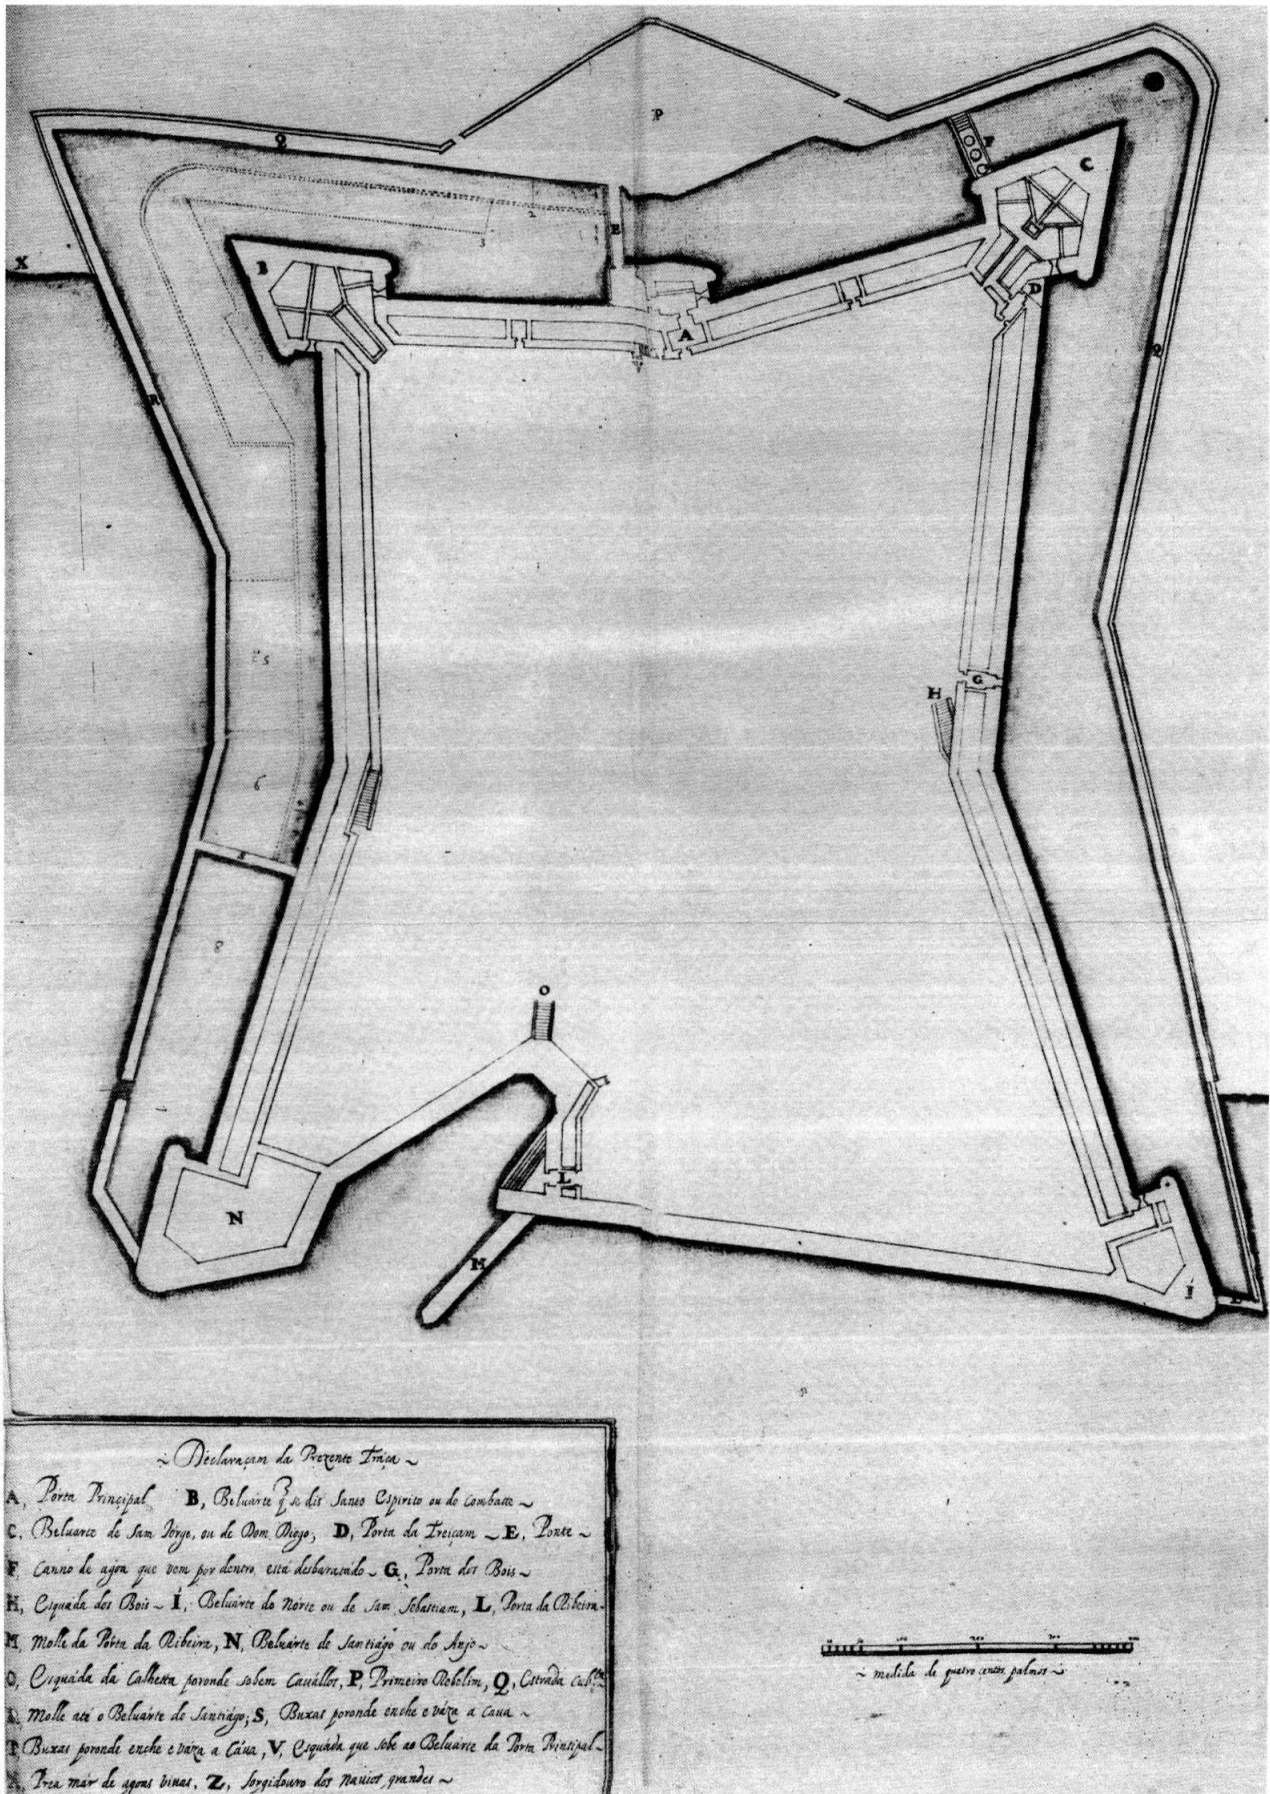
Fortaleza de Mazagão. Planta de 1611.
